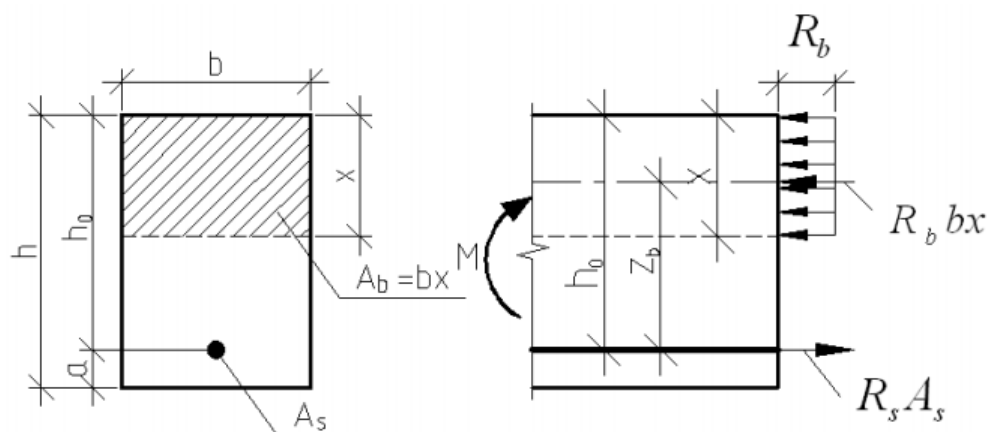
Схема усилий в нормальном сечении изгибаемого элемента с одиночной арматурой.
